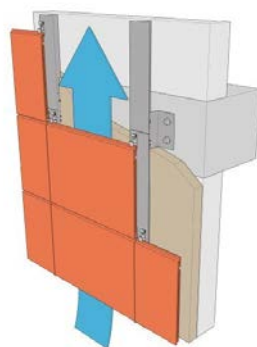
Ejemplo fachada ventilada. (Fuente: Favemanc)
